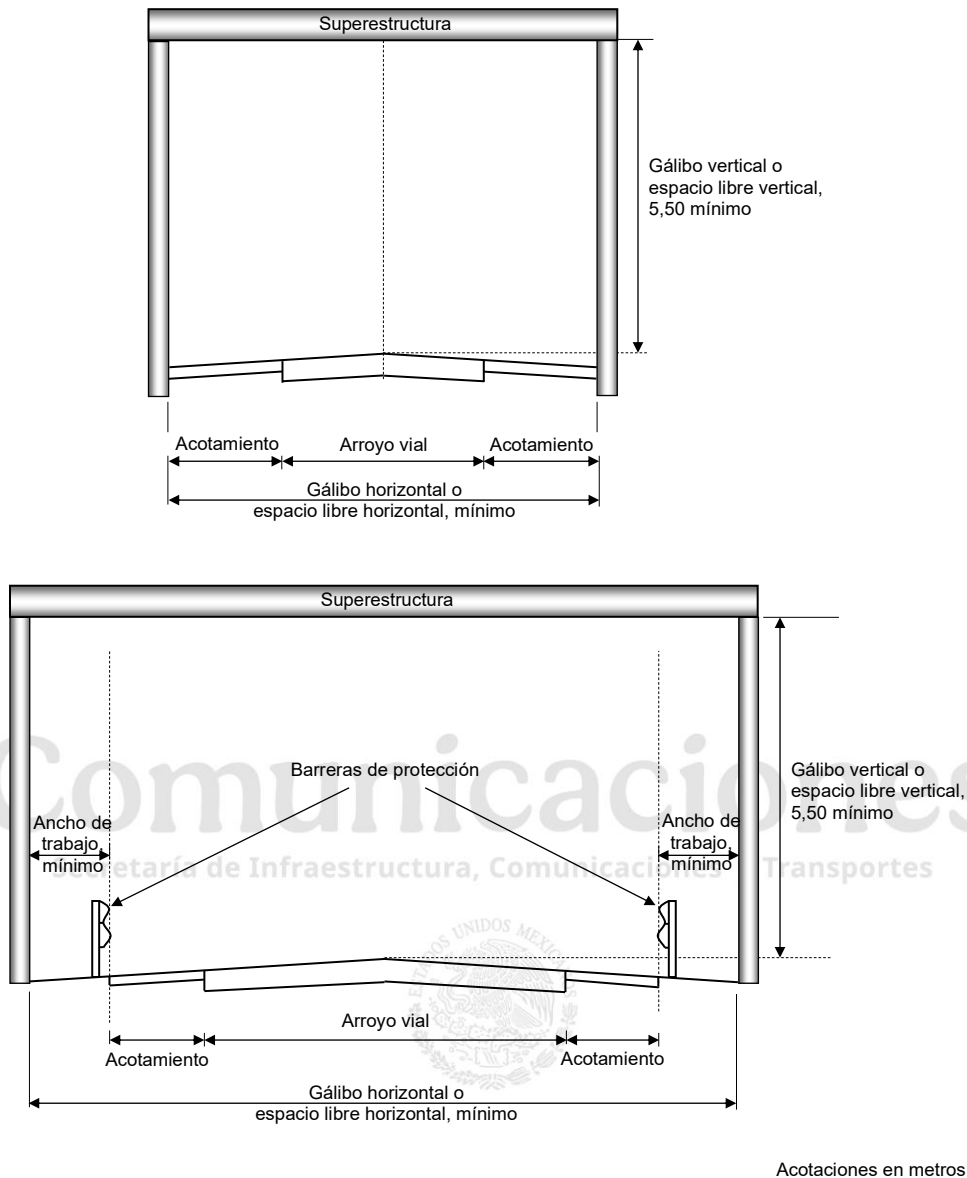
Gálibos o espacios libres vertical y horizontal mínimos para estructuras que crucen una carretera
